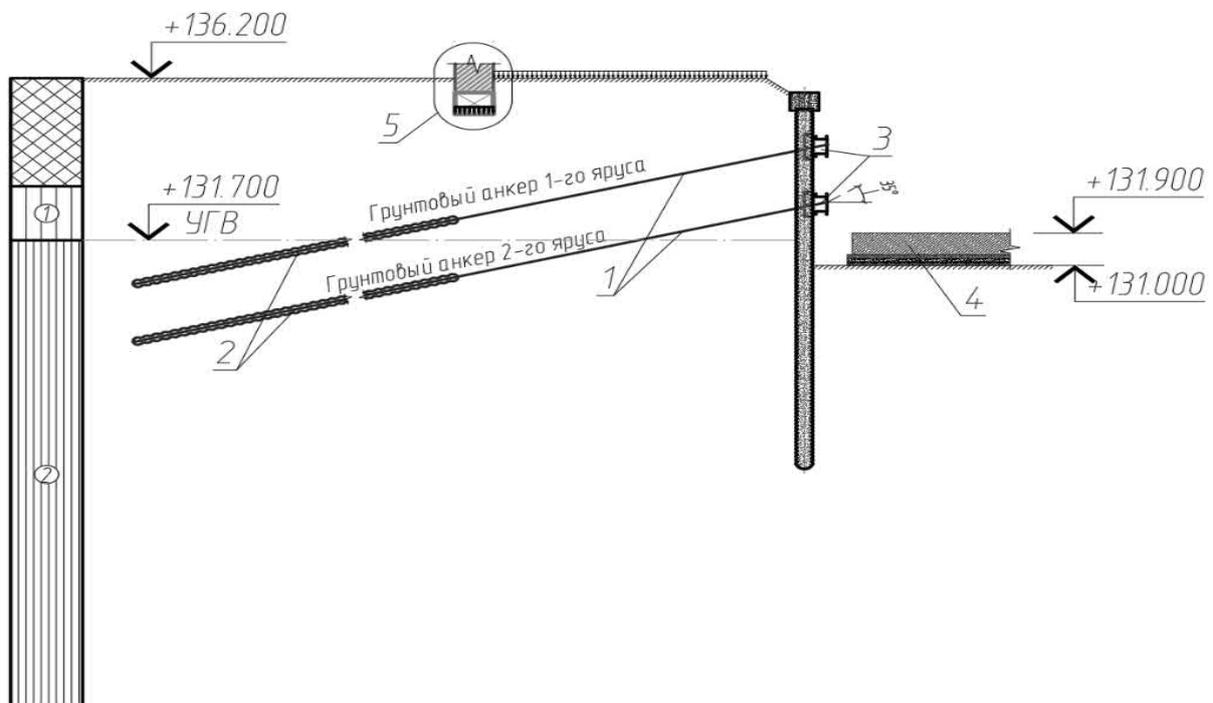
Характерный разрез ограждения котлована: 1, 2 - грунтовые анкера ЭРТ первого и второго уровней; 3 - стальные анкерные пояса; 4 – монолитный плитный фундамент строящегося 6 этажного объекта; 5 - фундамент одного из зданий существующей застройки
